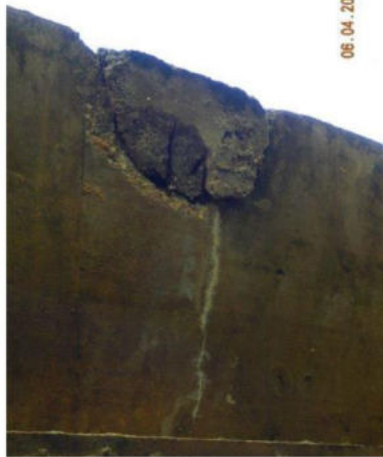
Fissura com eflorescência e concreto disgregado com armadura exposta e corroída na laje em balanço.
